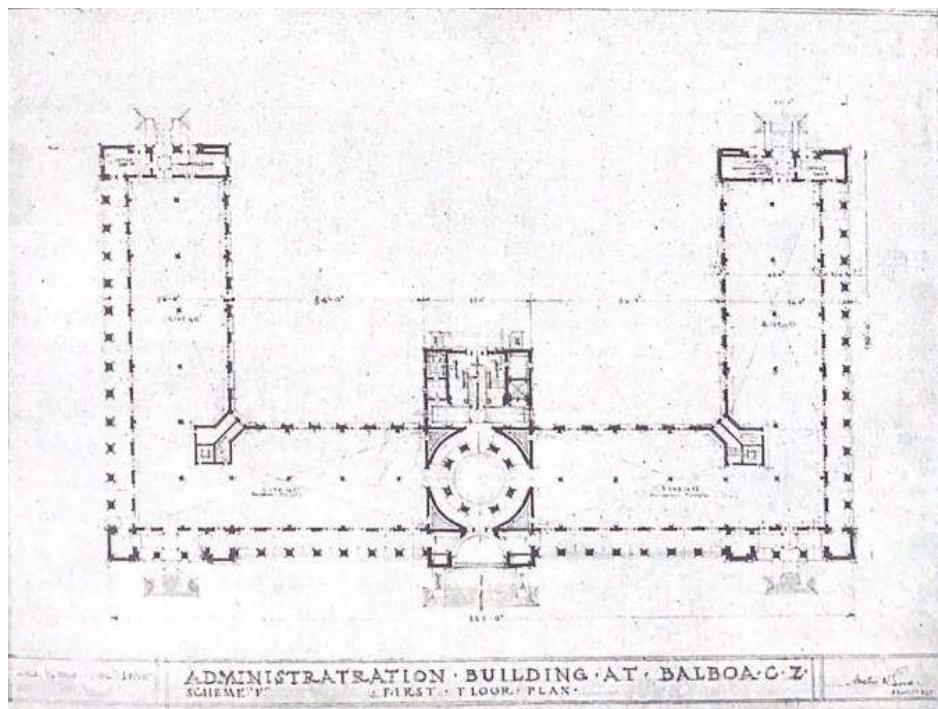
Edificio de la administración, planos publicados en mayo de 1914
